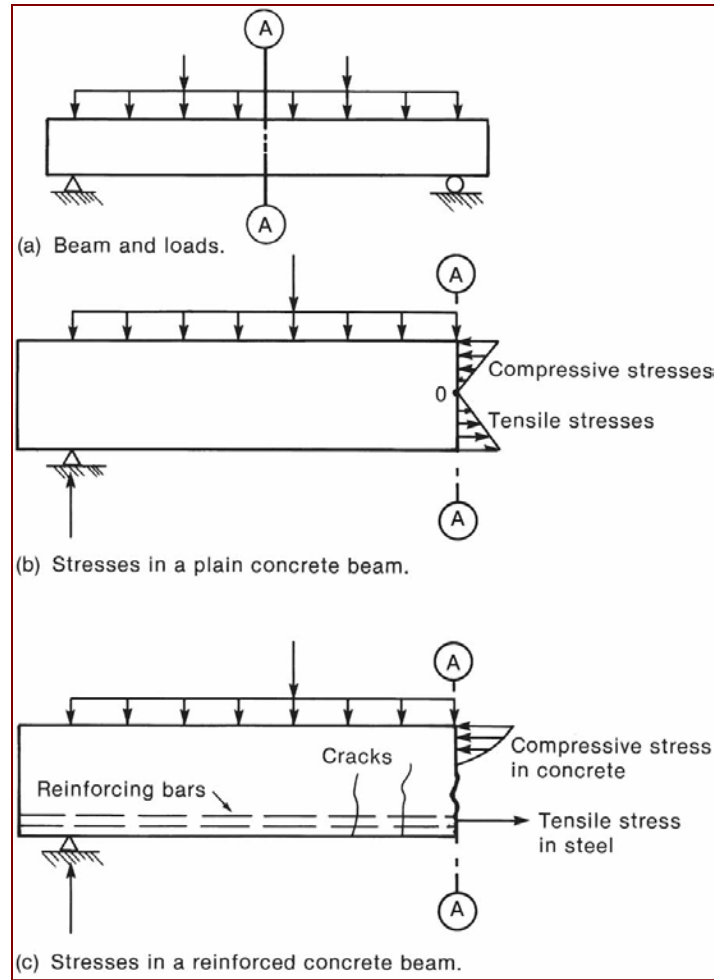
Vigas de concreto simple y concreto reforzado.
